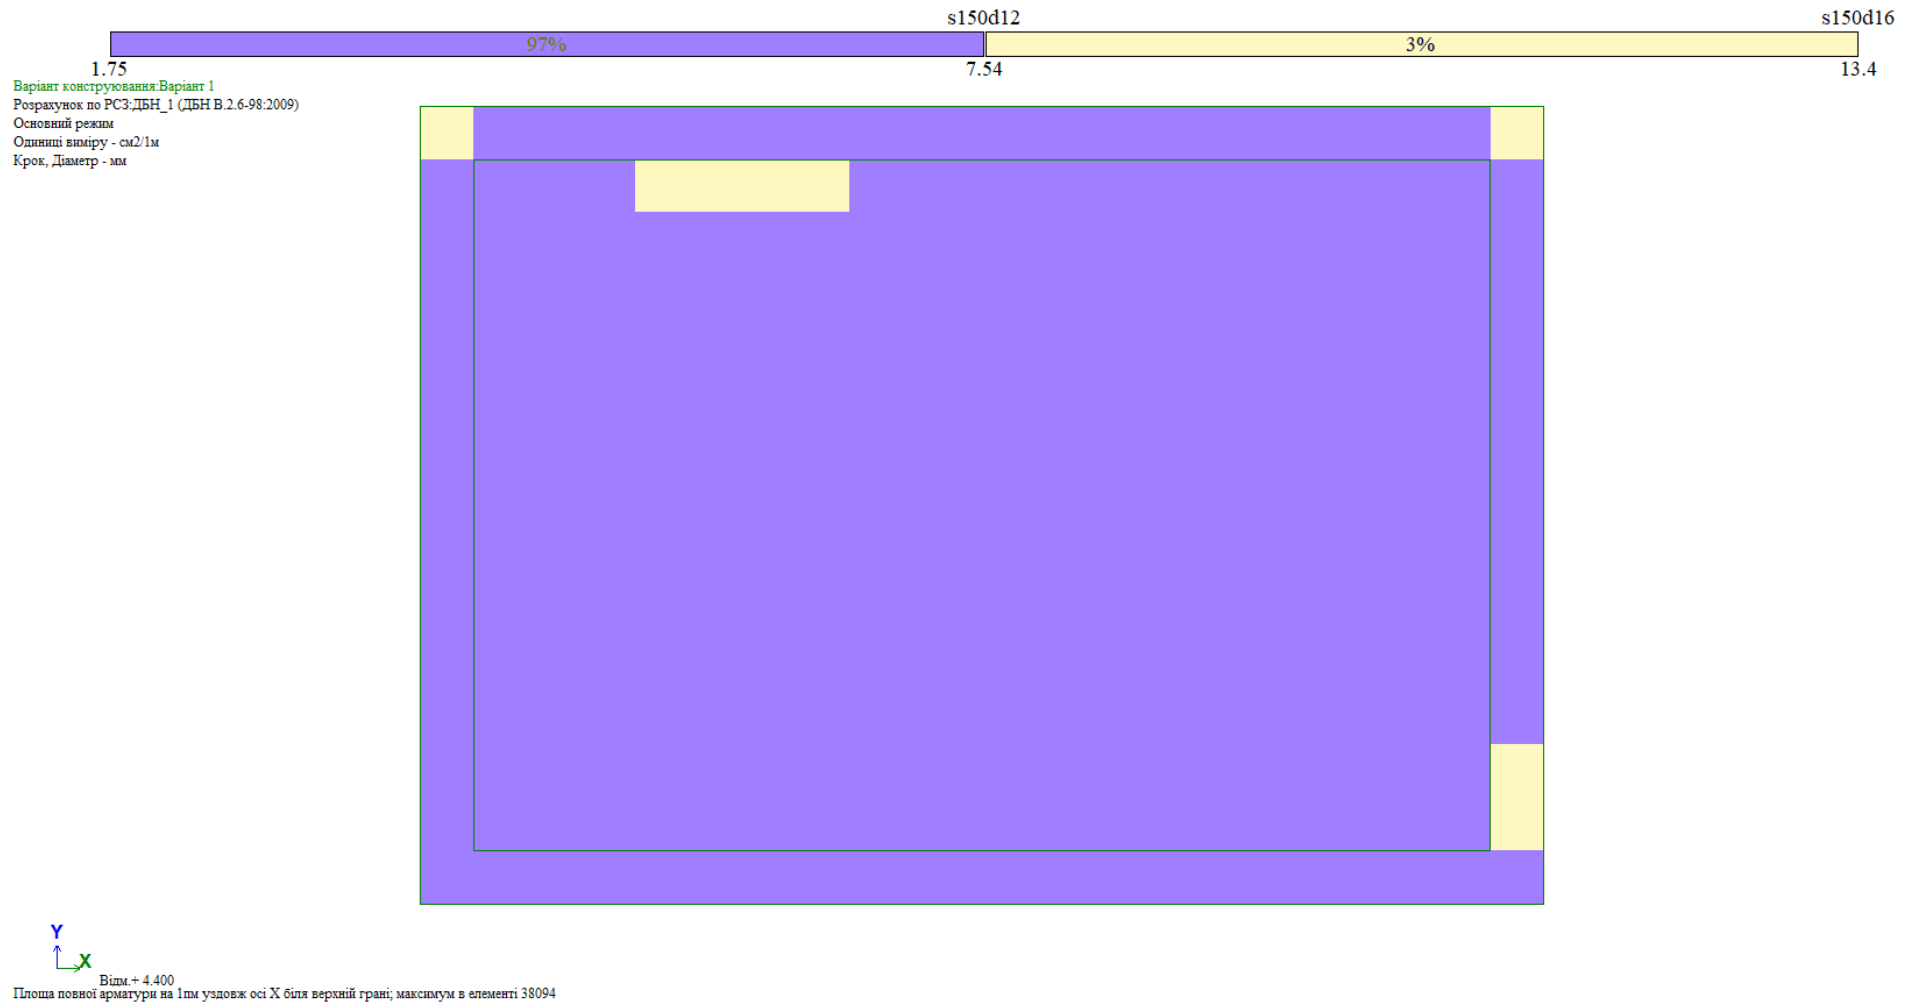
Армвання верхньої зони вздовж осі X (см²/1м) плити покриття над входом в сховище
